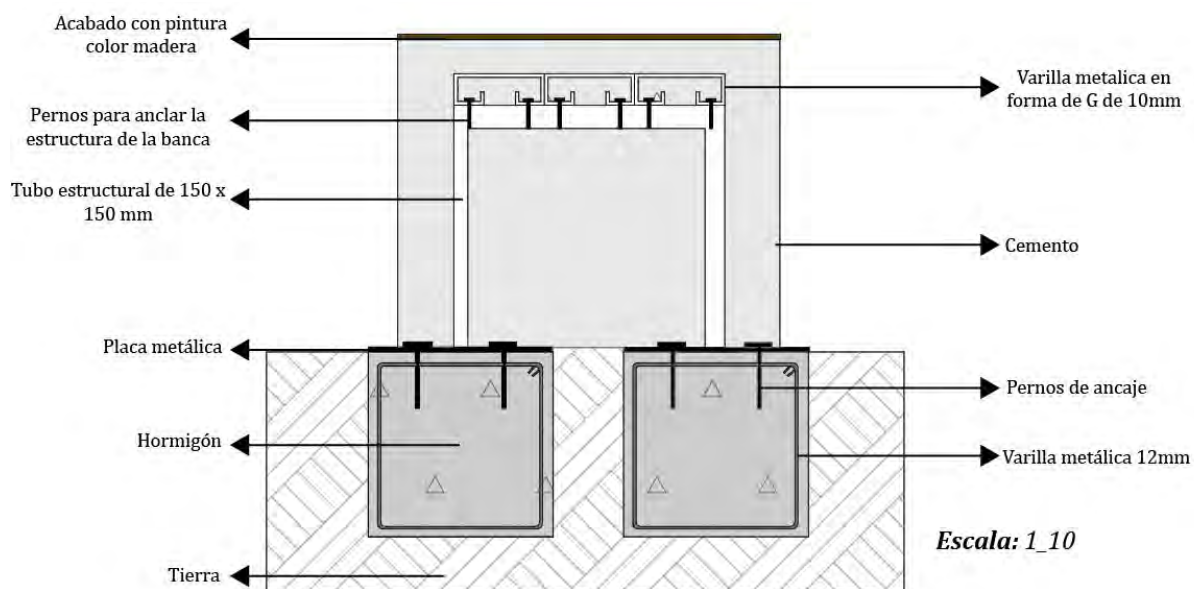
Detalle constructivo de cómo van a ir las sillas que forman las áreas de descanso dentro de la plaza. Fuente: Autora.
